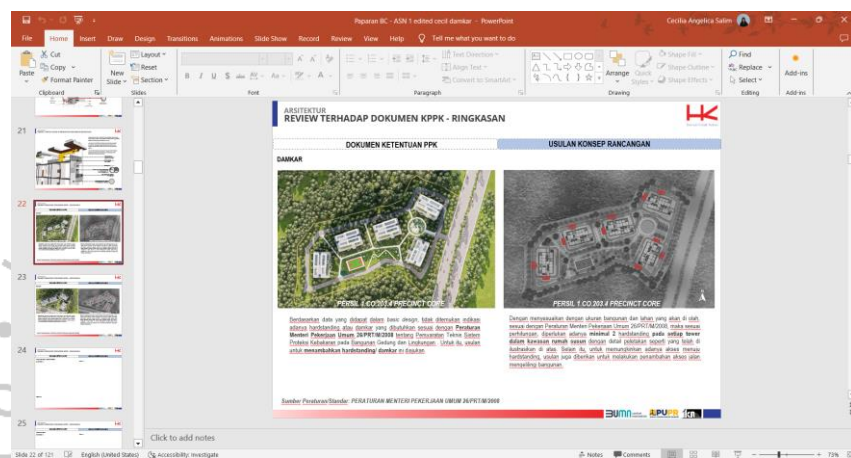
11. Siteplan Tower 1 Rusun Paspampres Praktikan (2023)
